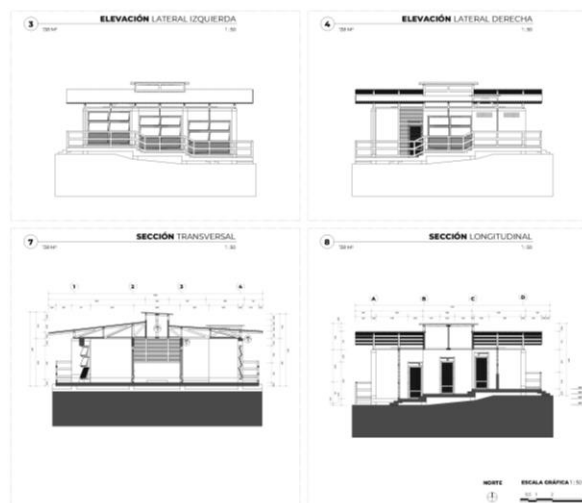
Planimetría Vivienda VRCPP Fase I
